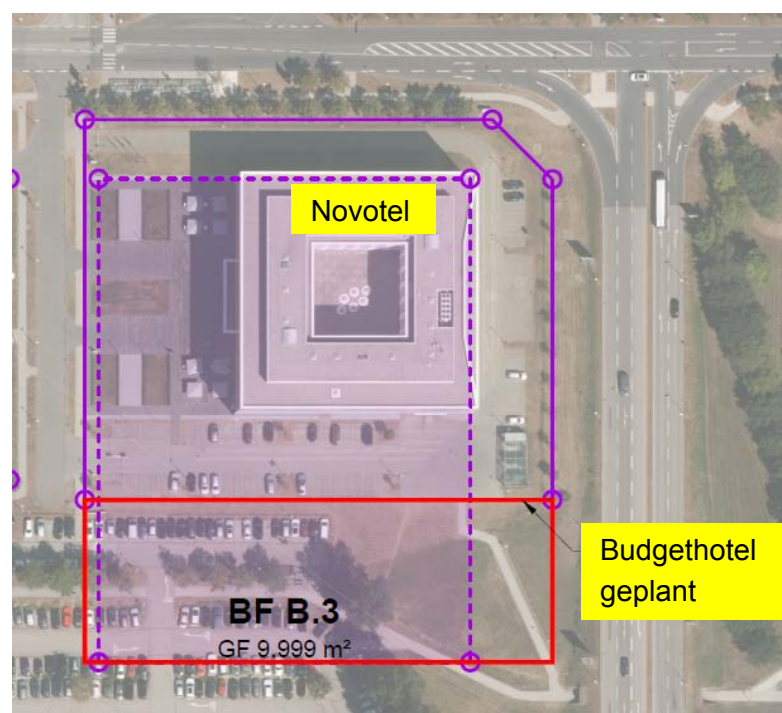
Lageplan Budgethotel im Baufeld B.3 [U10]
